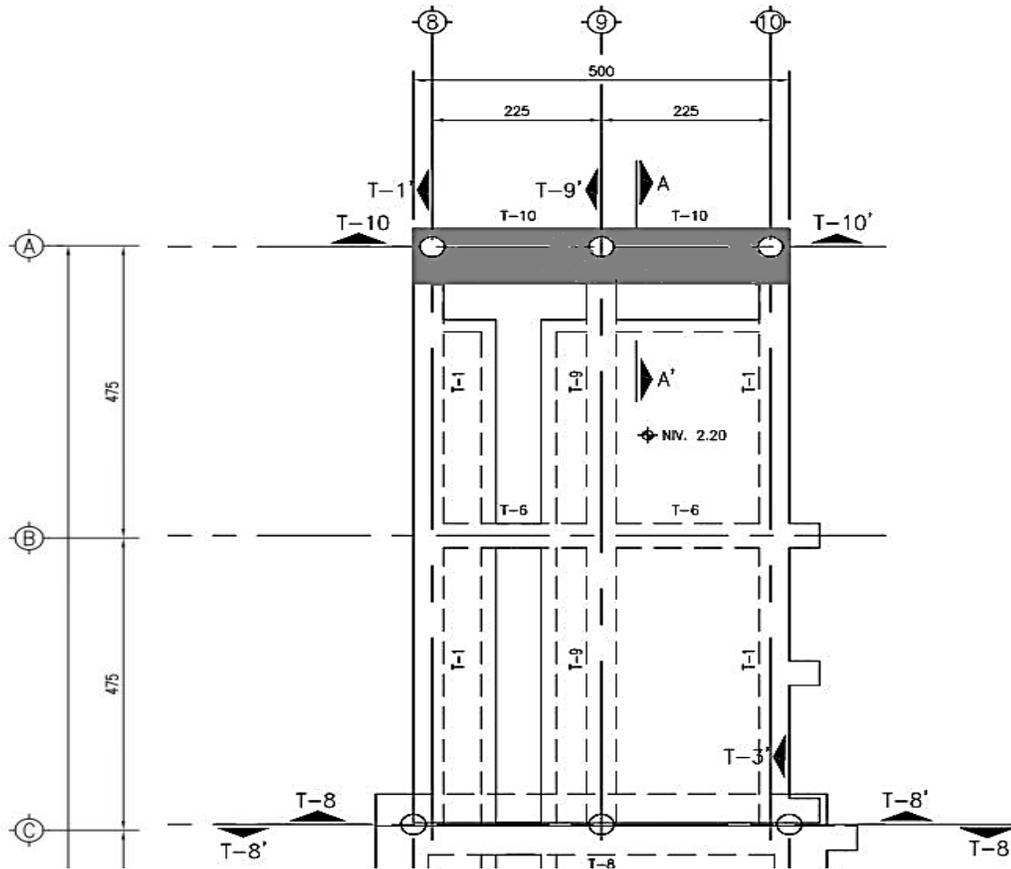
Planta de la cimentación para la Trabe T-10 en eje-A.
